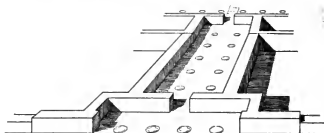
Der Vorraum mit Vorhalle nach dem aufgehenden Mauerwerk rekonstruiert.
